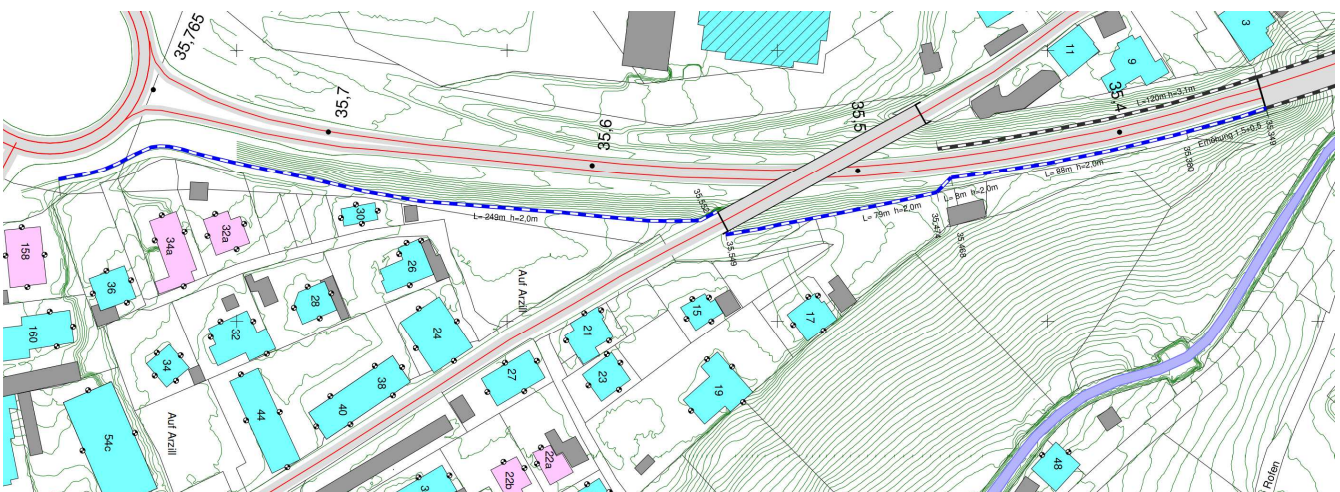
Übersichtslageplan mit baul. Schallschutz V02, Auszug aus Plan H016_22 /6/
